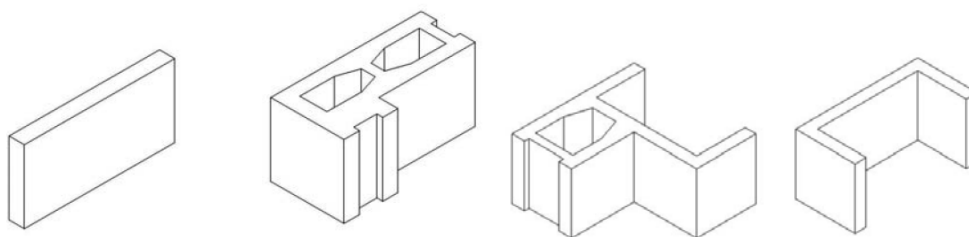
Plaqueta y bloque de encuentro para mantener el aparejo en determinados muros. Bloques para pilastro de enlace y pilastro sencilla.
